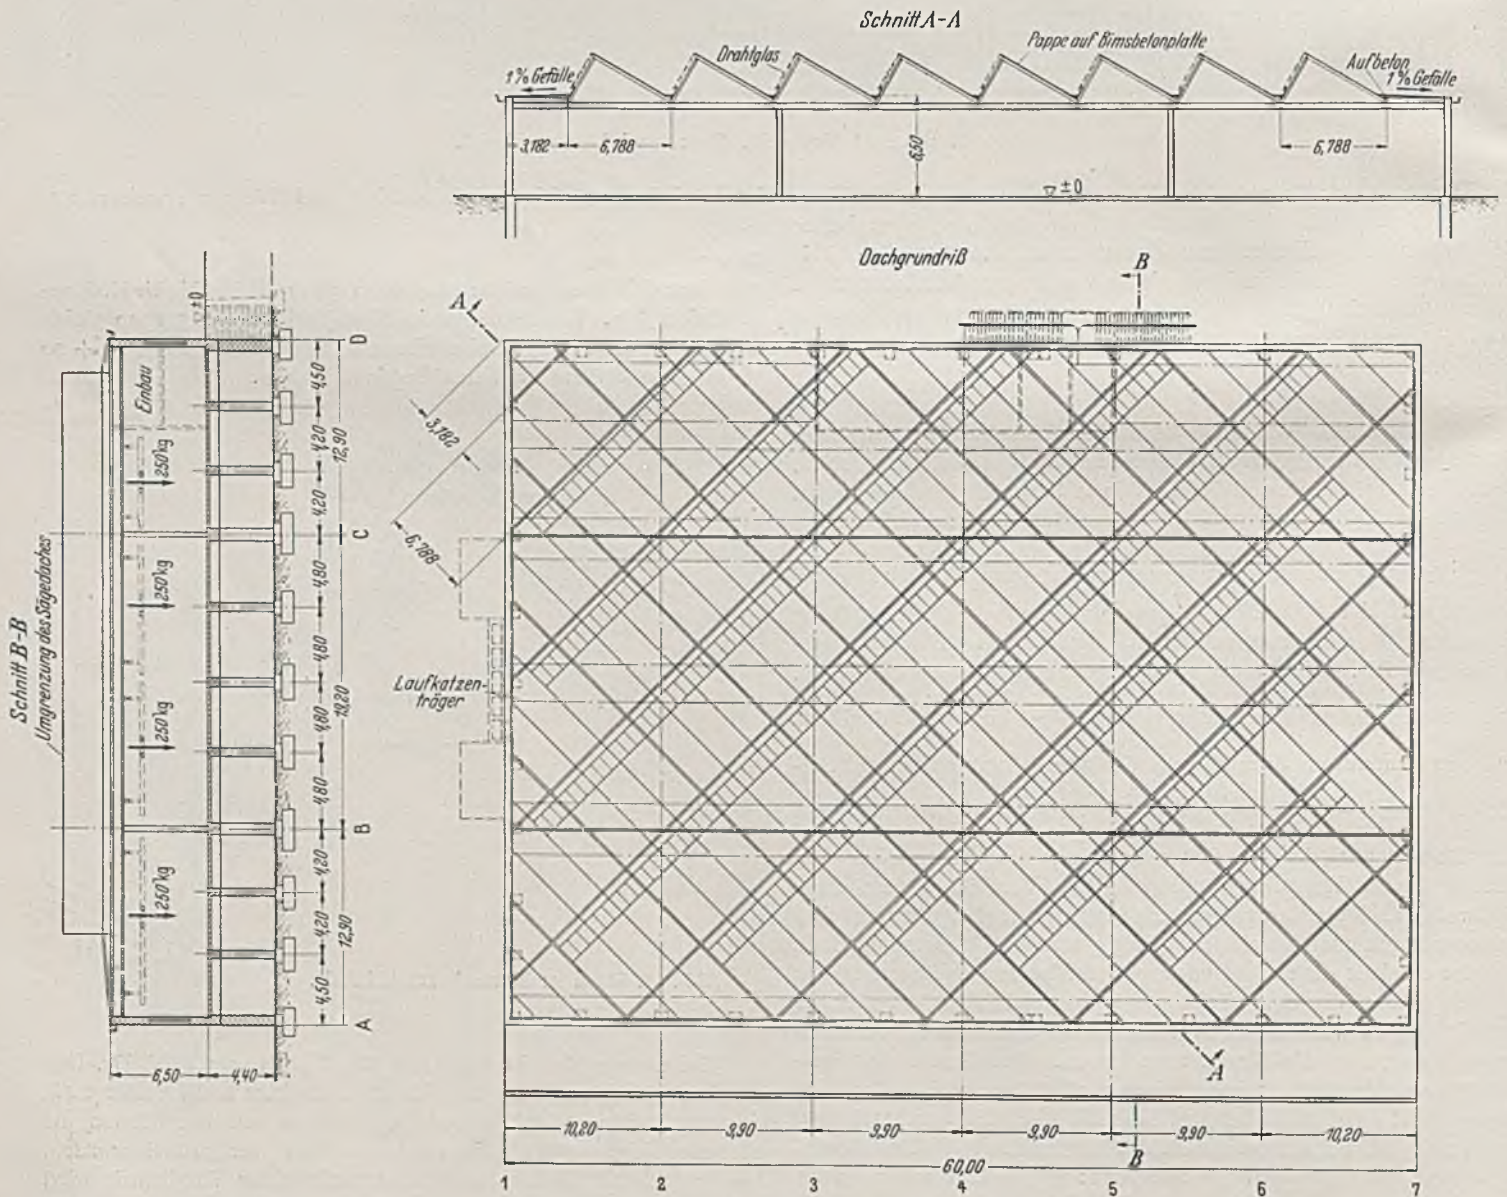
Bau 5: Grundriß, Quer- und Längenschnitt.
